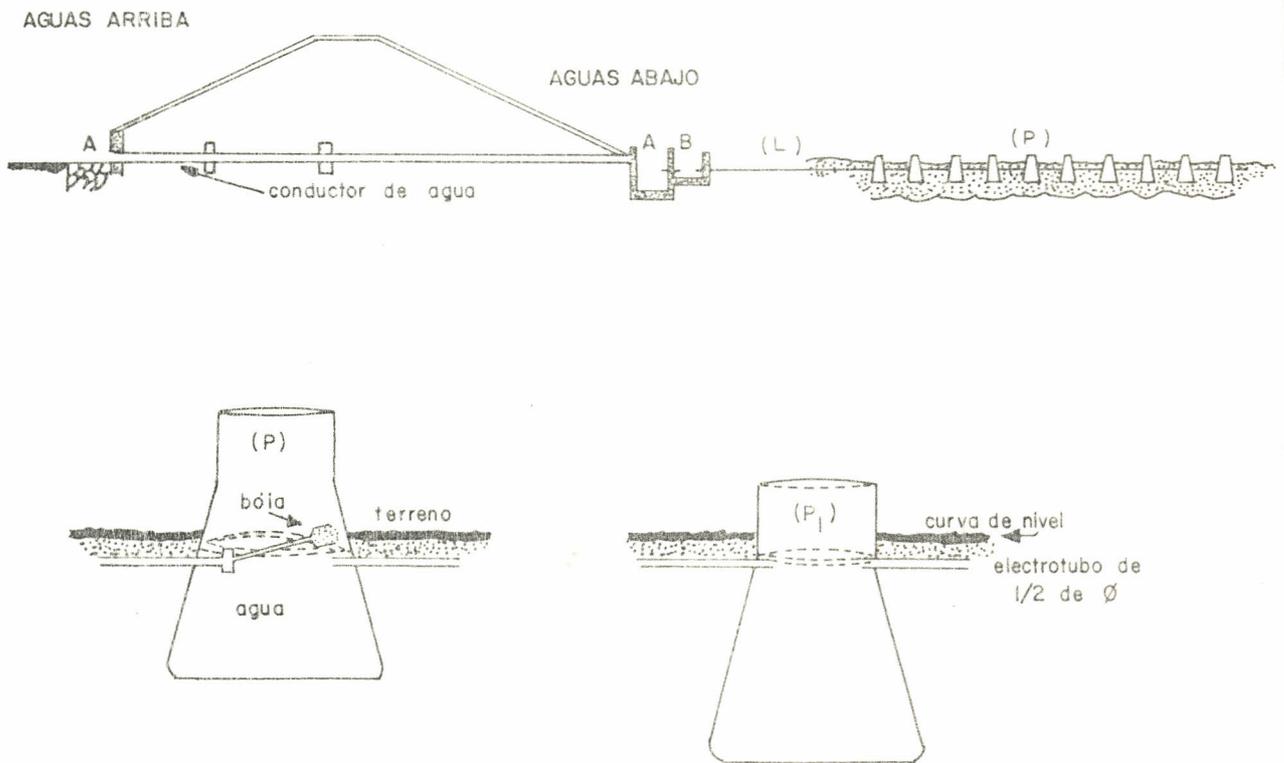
Sistema de riego por jarros de barro (Silva et.al., 1979).
